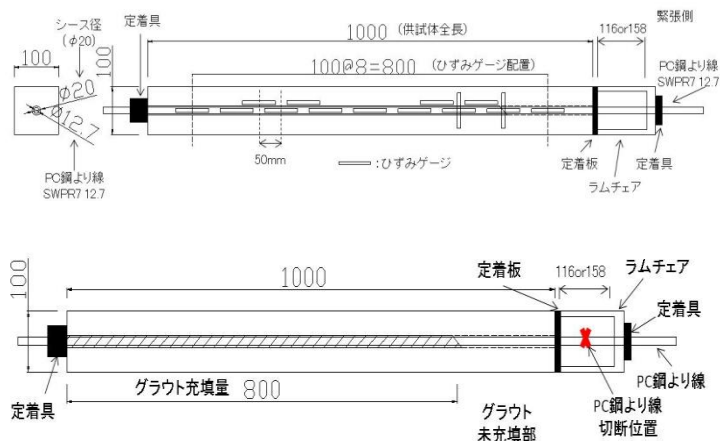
試験体概要およびひずみゲージの配置(単位 mm)
